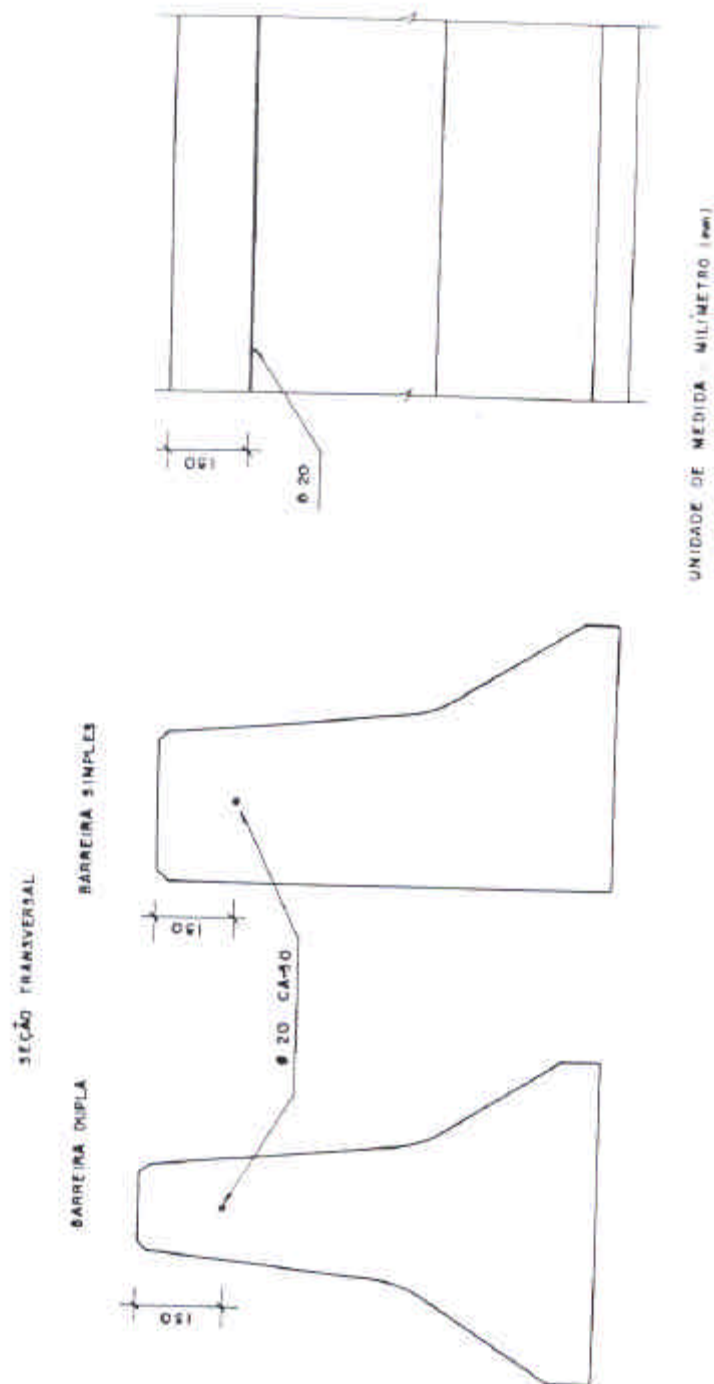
ARMAÇÃO – BARREIRAS PRÉ-MOLDADAS
